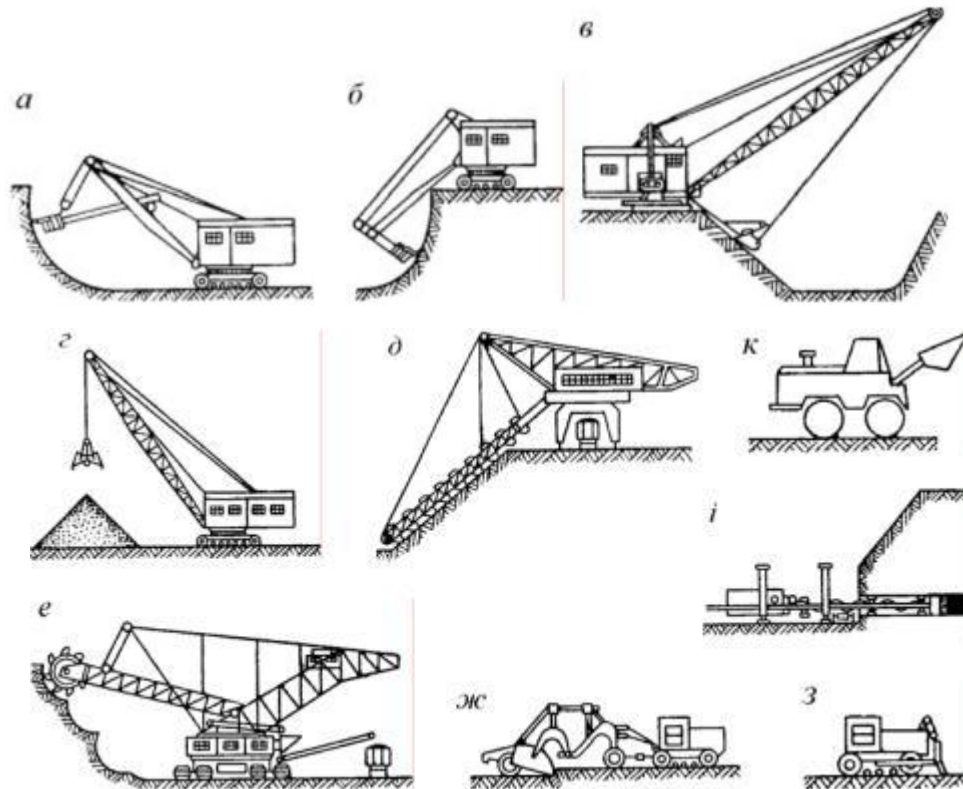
Схеми виймально-навантажувальних машин: а – пряма мехлопата; б – зворотня мехлопата; в – драглайн; г – грейфер; д – ланцюговий багатоковшевий екскаватор; е – роторний екскаватор; ж - колісний скрепер; з – бульдозер; і – шнекобурова машина; к – навантажувальник
